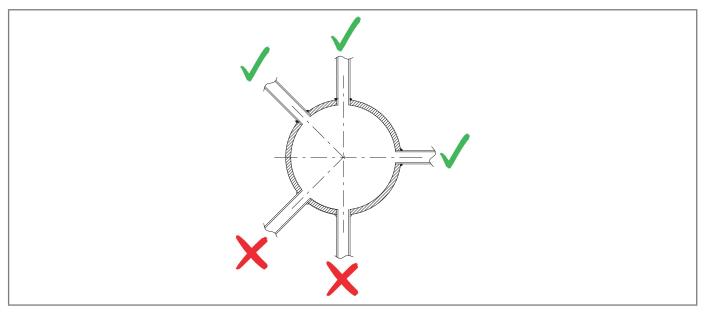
Conexiones soldadas de la tubería
